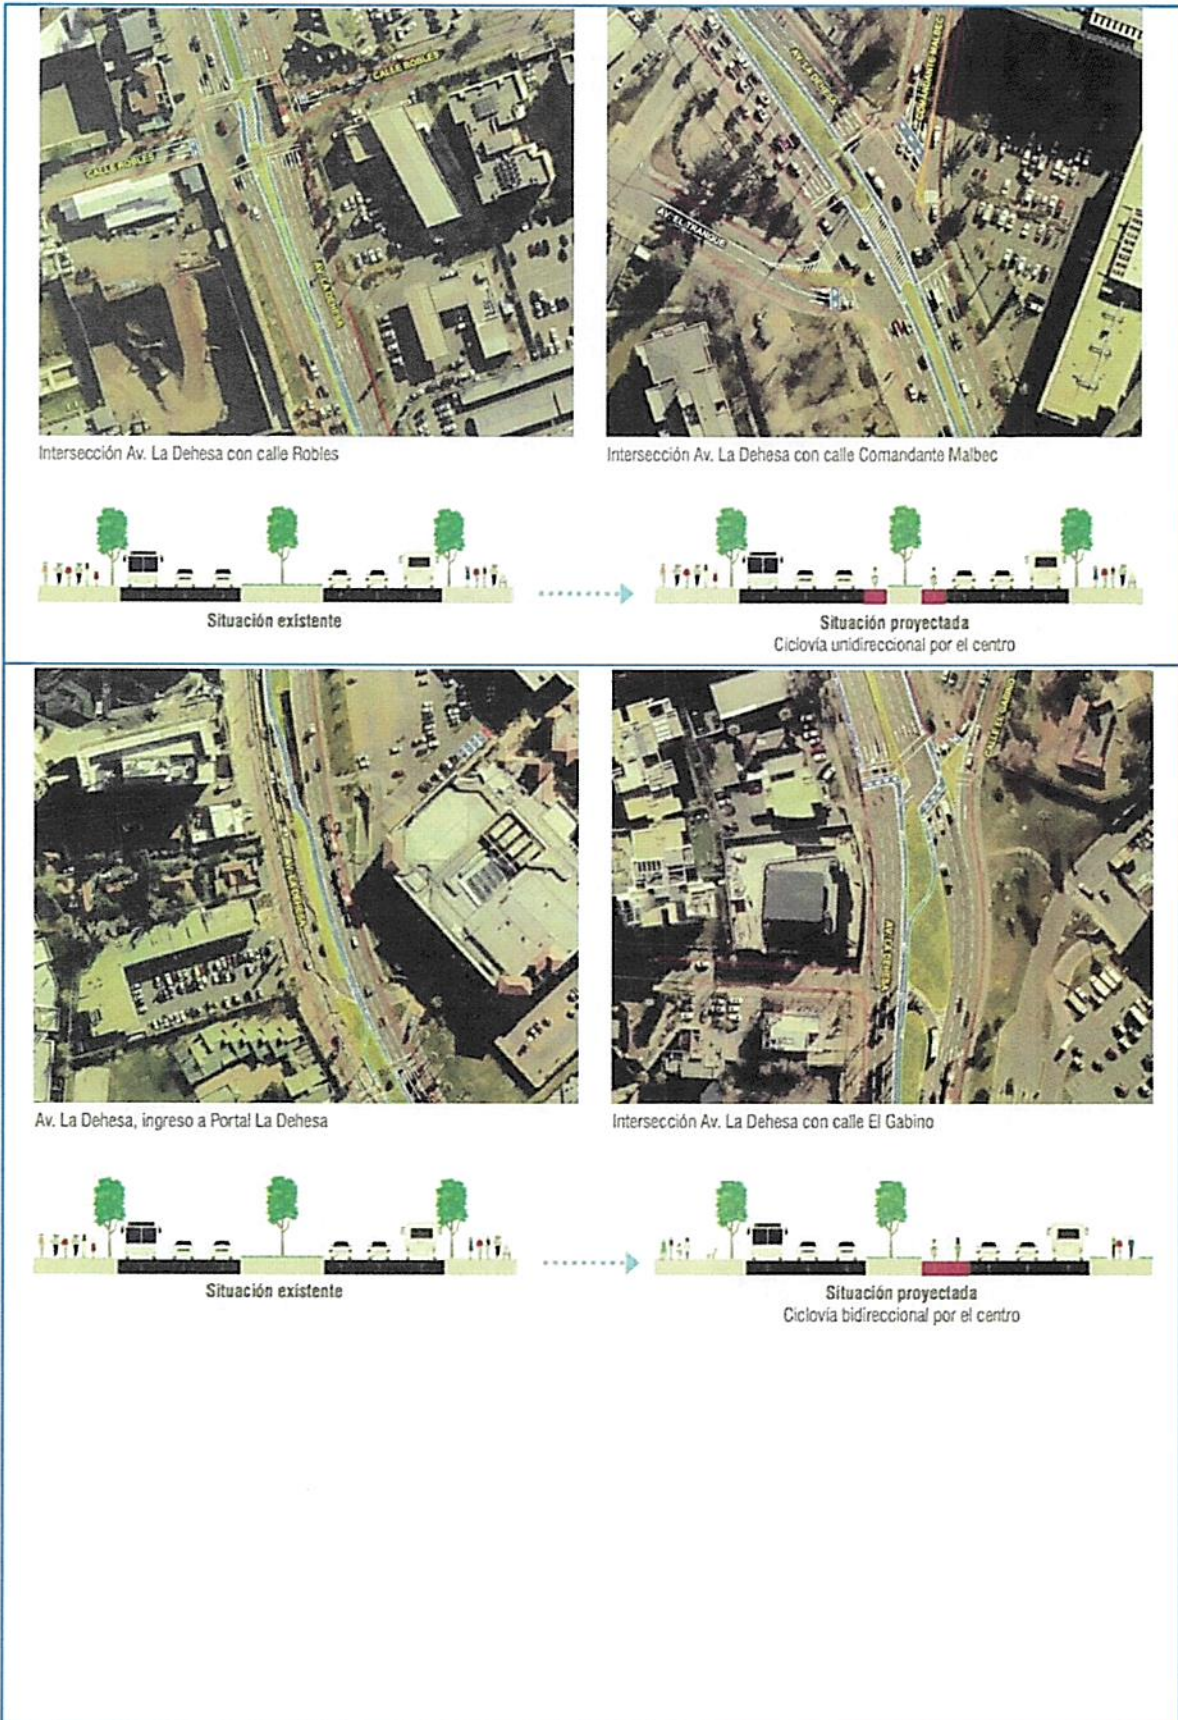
Mapa y plan de implementación de ciclovías en Av. La Dehesa
